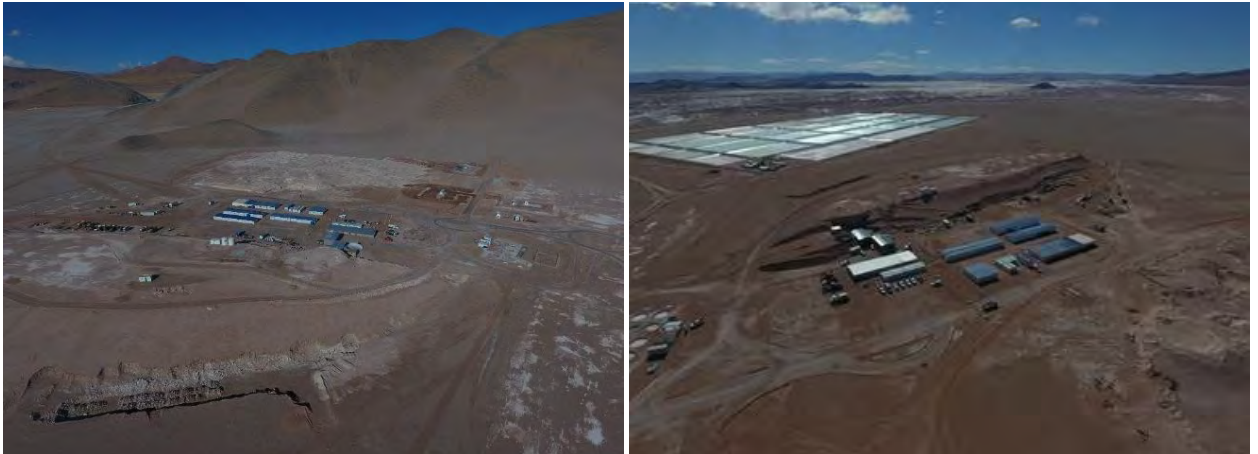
Vista del campamento y piletas, hacia noroeste al fondo se observa el salar.
